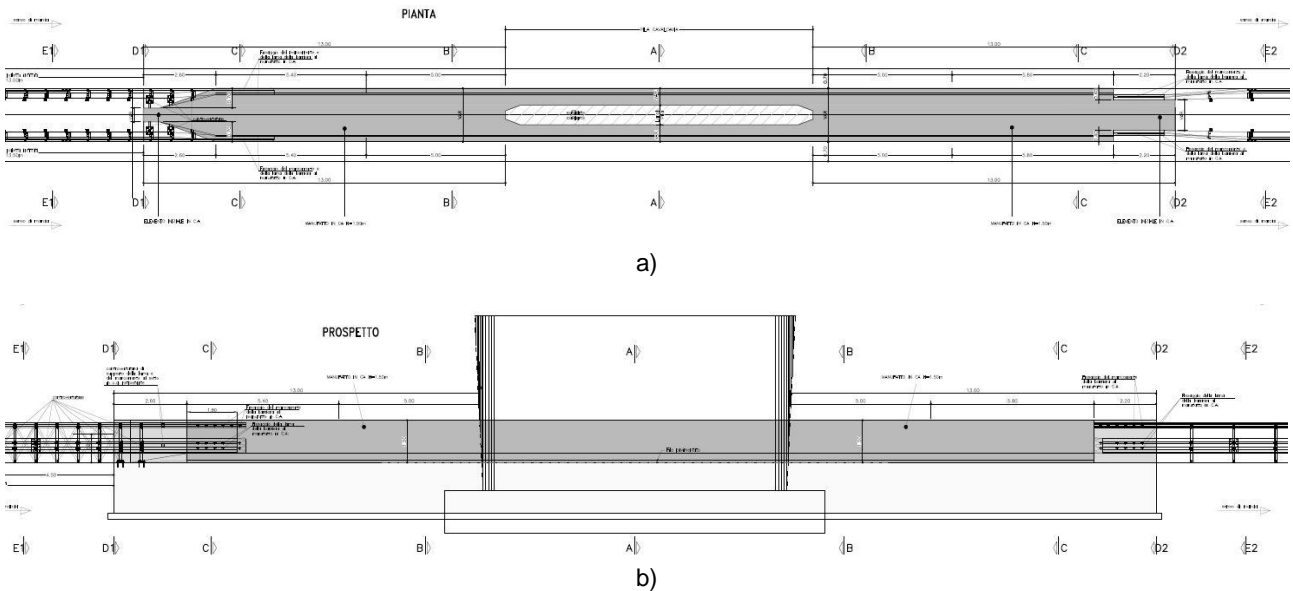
Barriera di sicurezza metallica per protezione pila singola cavalcavia: stralcio planimetrico a); prospetto laterale b).
